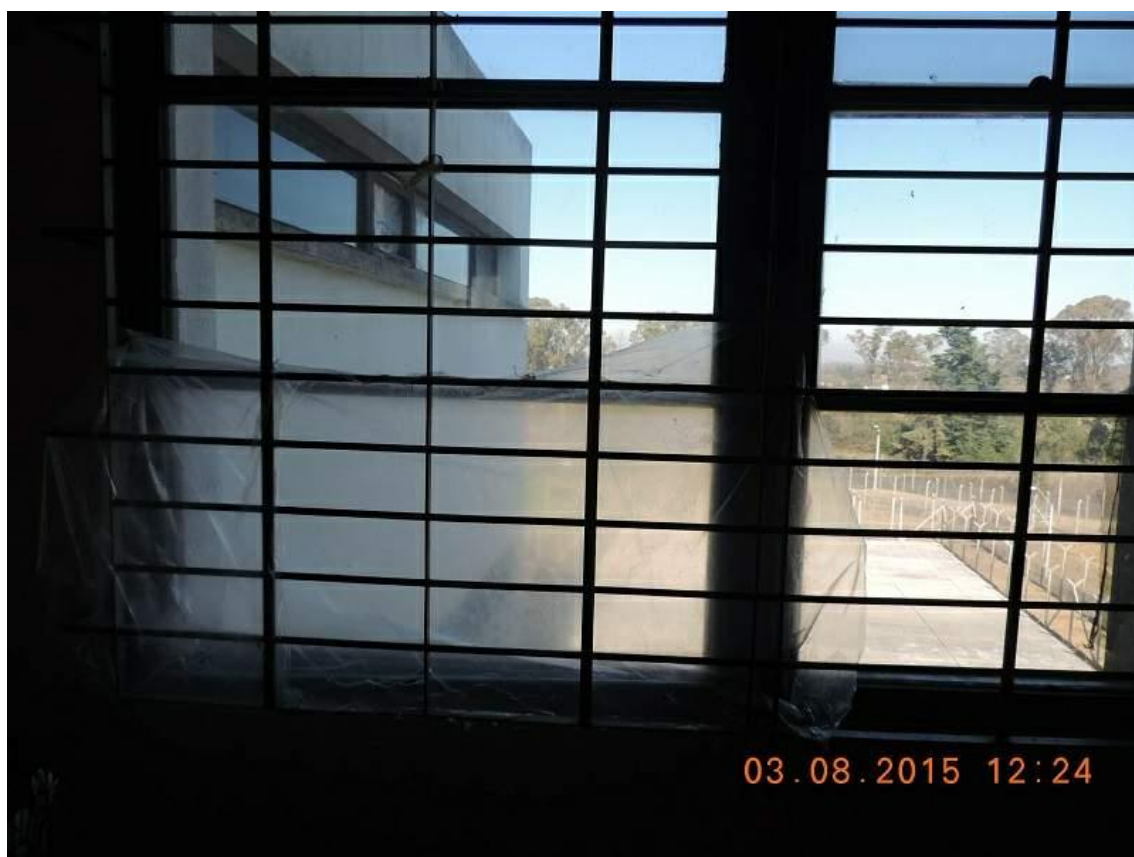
Ventanas cubiertas con nylon en 3° Rampa Oeste
